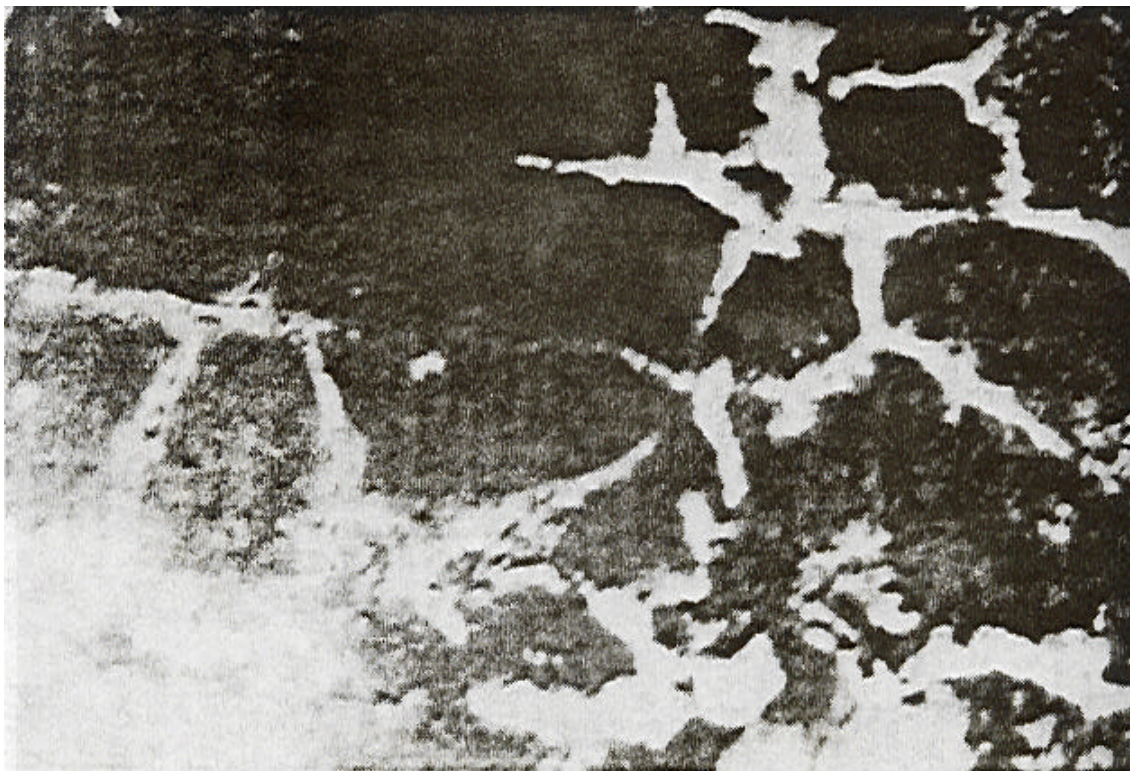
Exsudação de gel da RAA em fissuras de expansão- Obra no Brasil.
